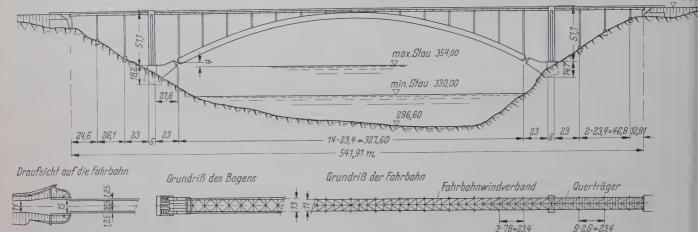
Ansicht und Grundriß einer Straßenbrücke über einen Stausee
